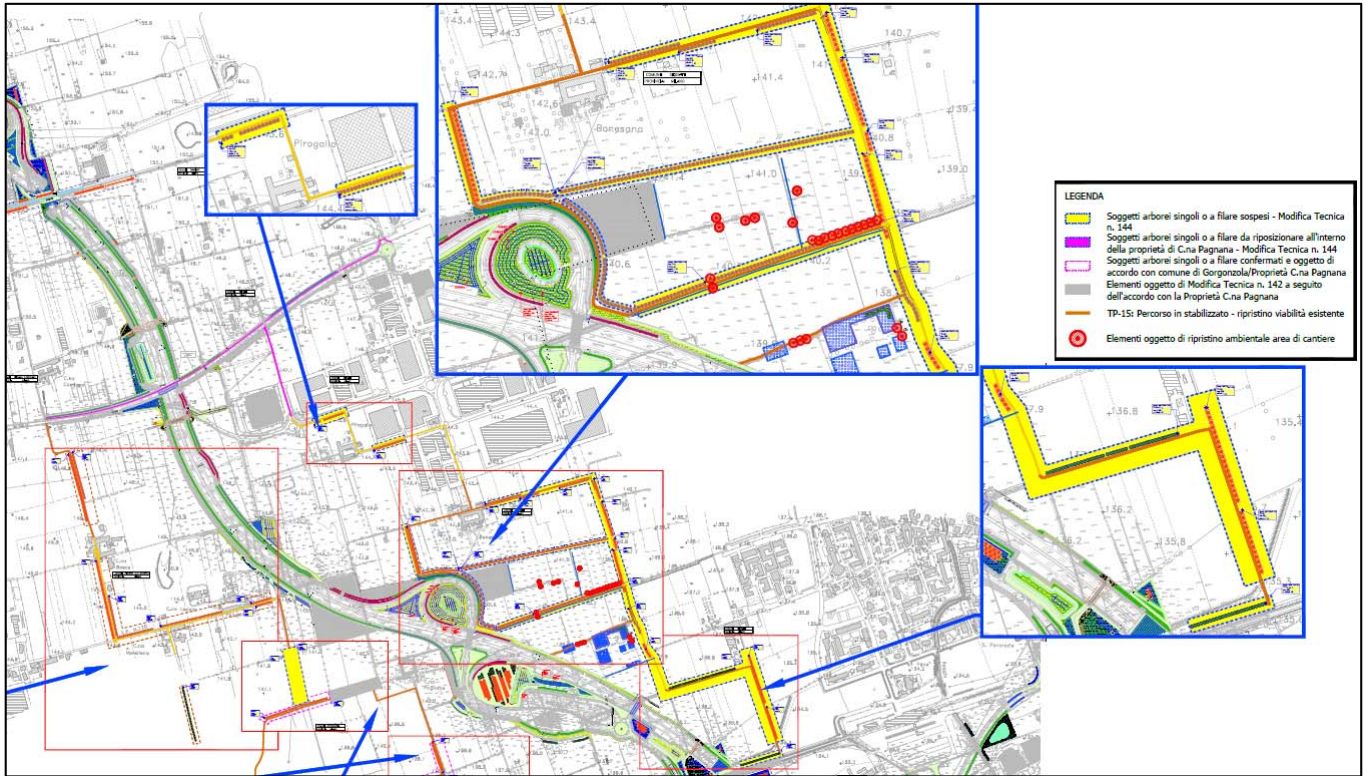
Stralcio planimetrico filari a nord di TEEM
